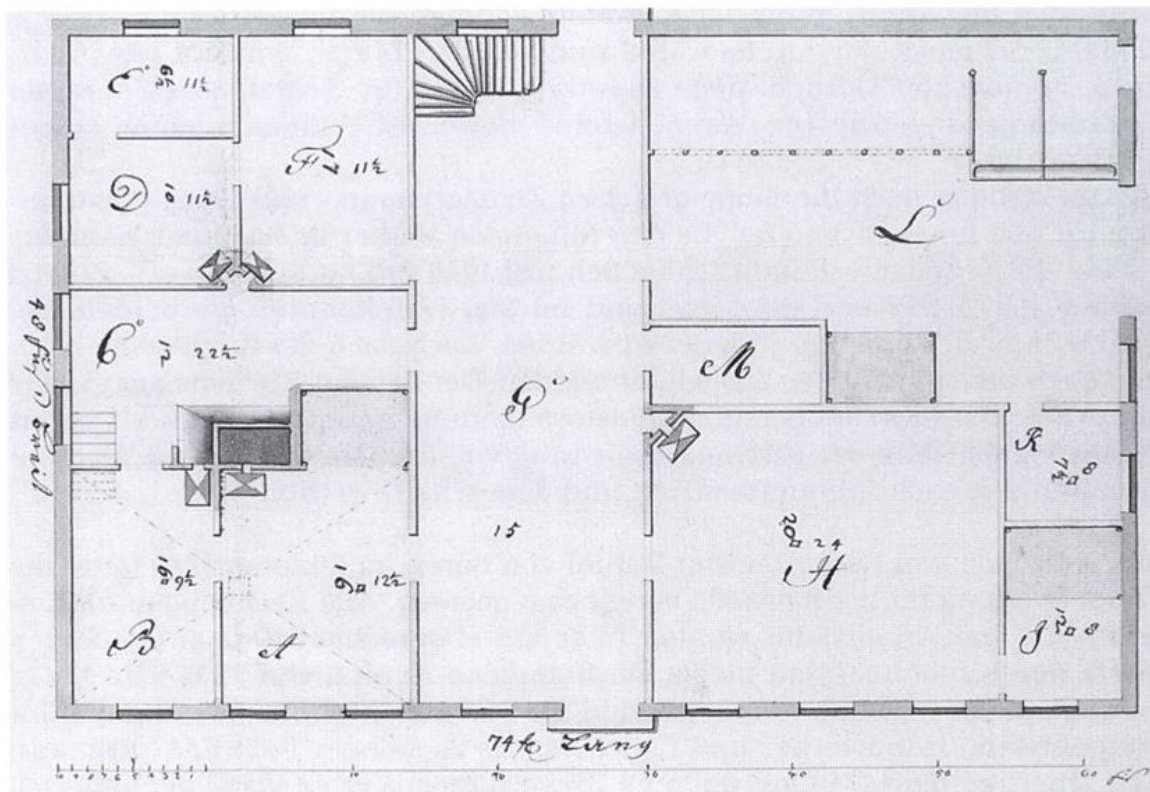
Grundriß des Predigerhauses zu Rablinghausen.
